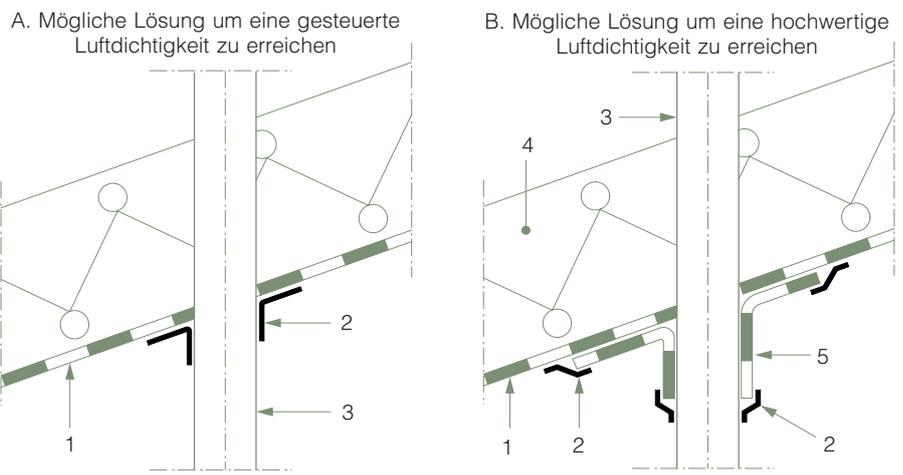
PE-Folie, angebracht während der Errichtung der Dachsparren.
